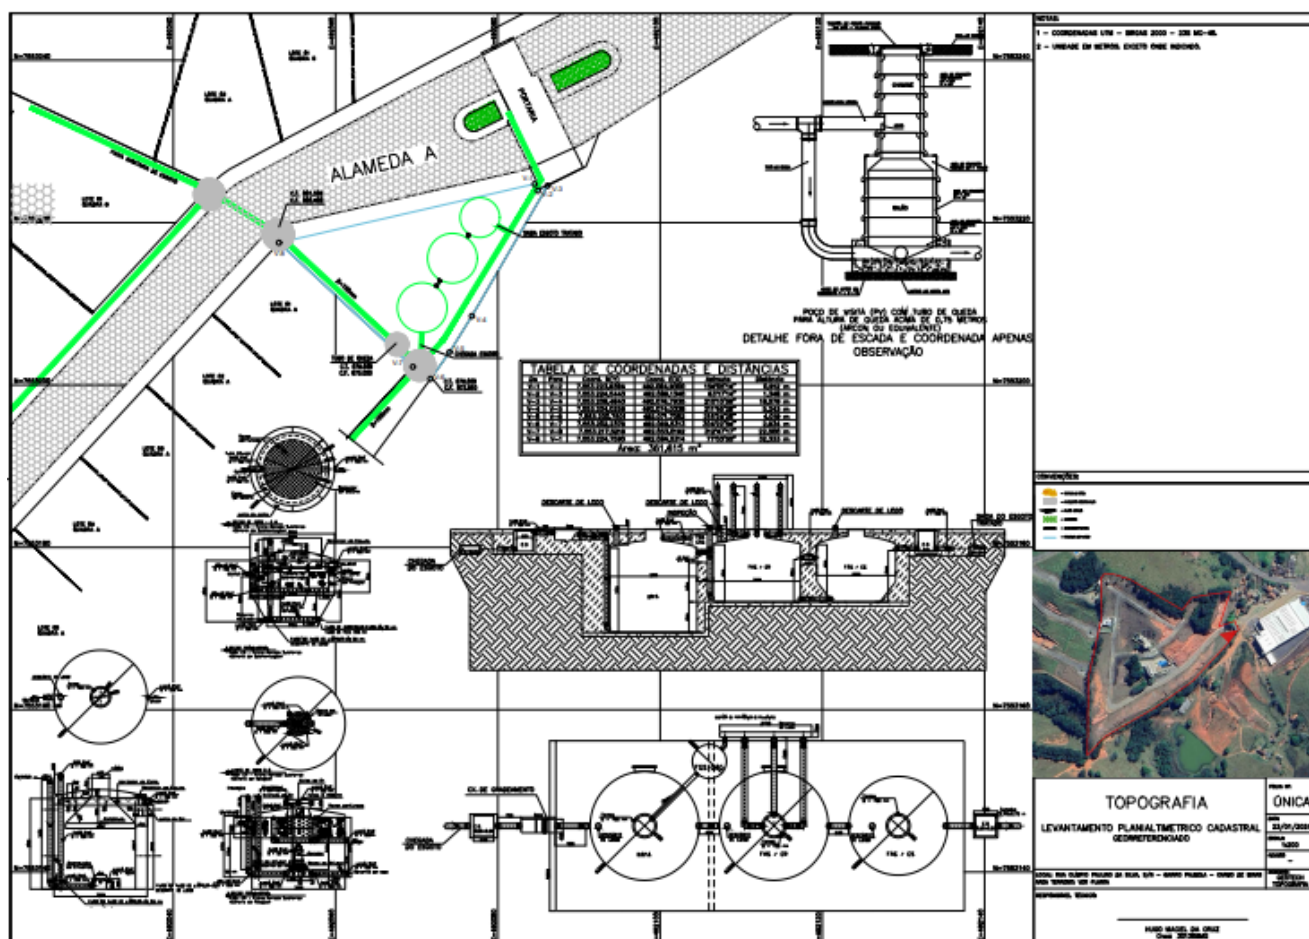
Planta Planialtimétrica com as estruturas da ETE.
